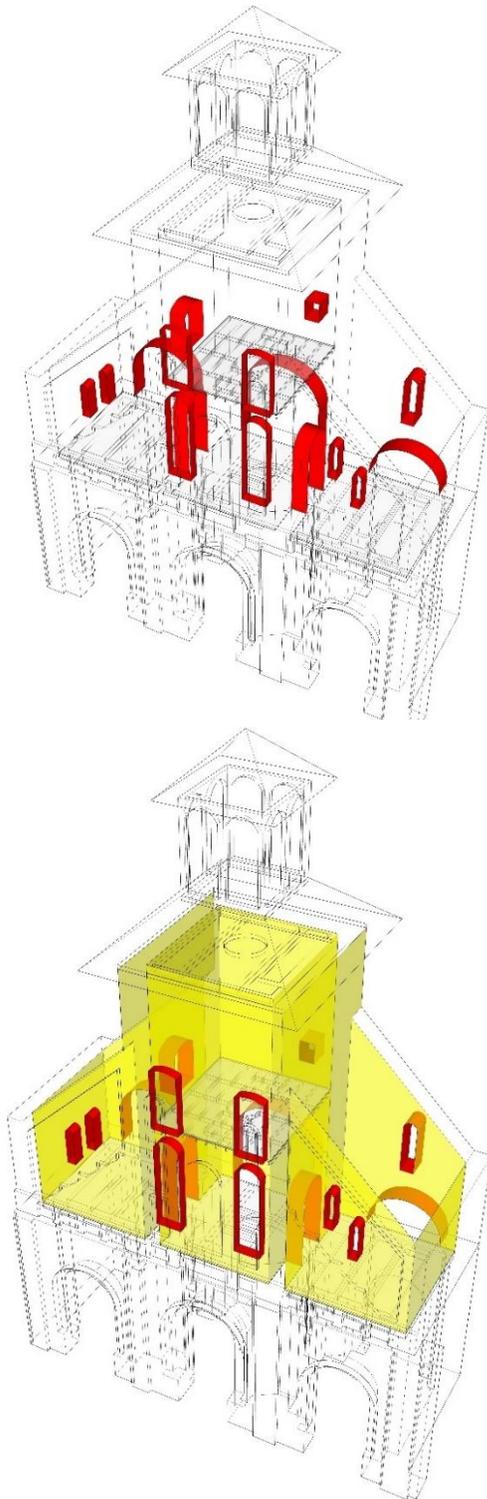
Esquemas de ejecución de refuerzo. Arriba: En rojo se indican vanos a consolidar con pletina metálica en intradós. Abajo: Muros en amarillo con refuerzos interiores de superficie con malla. Elab. Propia.
